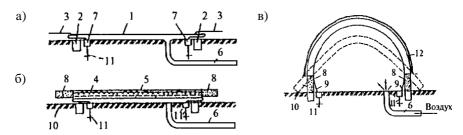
Пневматическая подъемная опалубка сводов а – подготовленная опалубка, б – опалубка с уложенной бетонной смесью, в – поднятая опалубка, 1 – пневмоопалубка, 2 – фундамент, 3 – открылки, 4 – спиральная арматура, 5 – бетонная смесь, 6 – трубопровод для нагнетания воздуха, 7 – опорные трубы, 8 – участки свода (стены), 9 – участки пневмоопалубки не соприкасающиеся с бетоном, 10 – фундамент, 11 – анкеры, 12 – натяжная внешняя оболочка.
